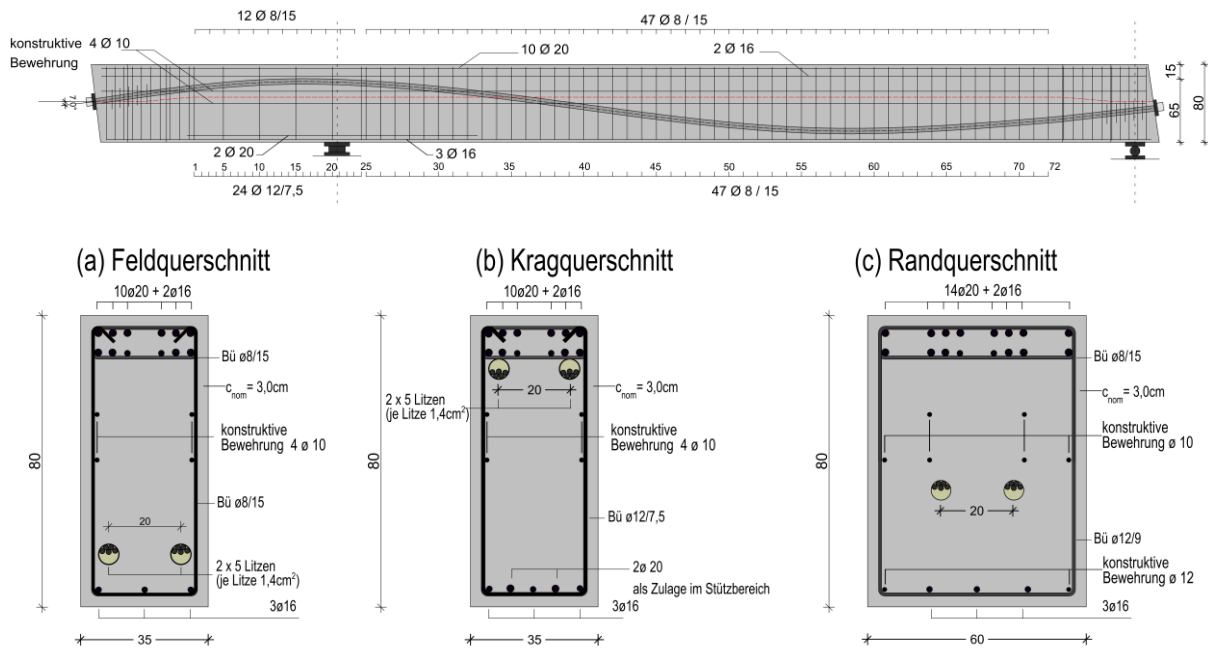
Bewehrungsplan Versuchsträger ETK5
